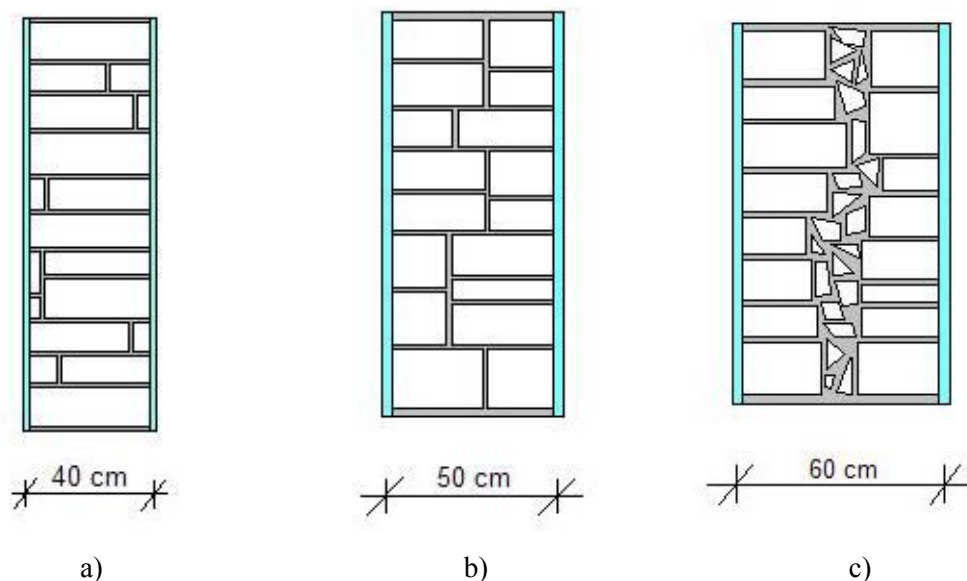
Paredes pouco espessas de edificios antigos: a) uma fiada de pedra aparelhada; b) duas fiadas de pedra aparelhada; c) duas fiadas de pedra aparelhada com enchimento central
